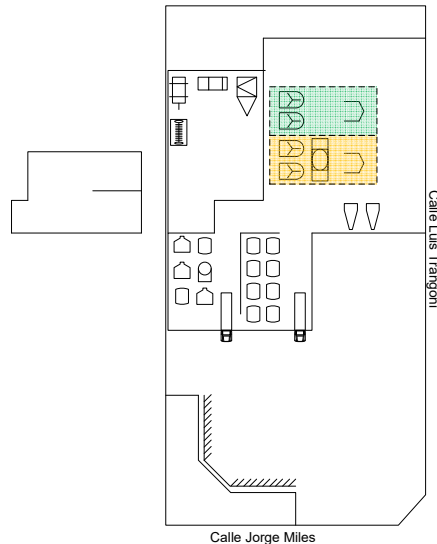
Distribución de Sectores, Maquinaria y Materiales sobre Lay-Out
